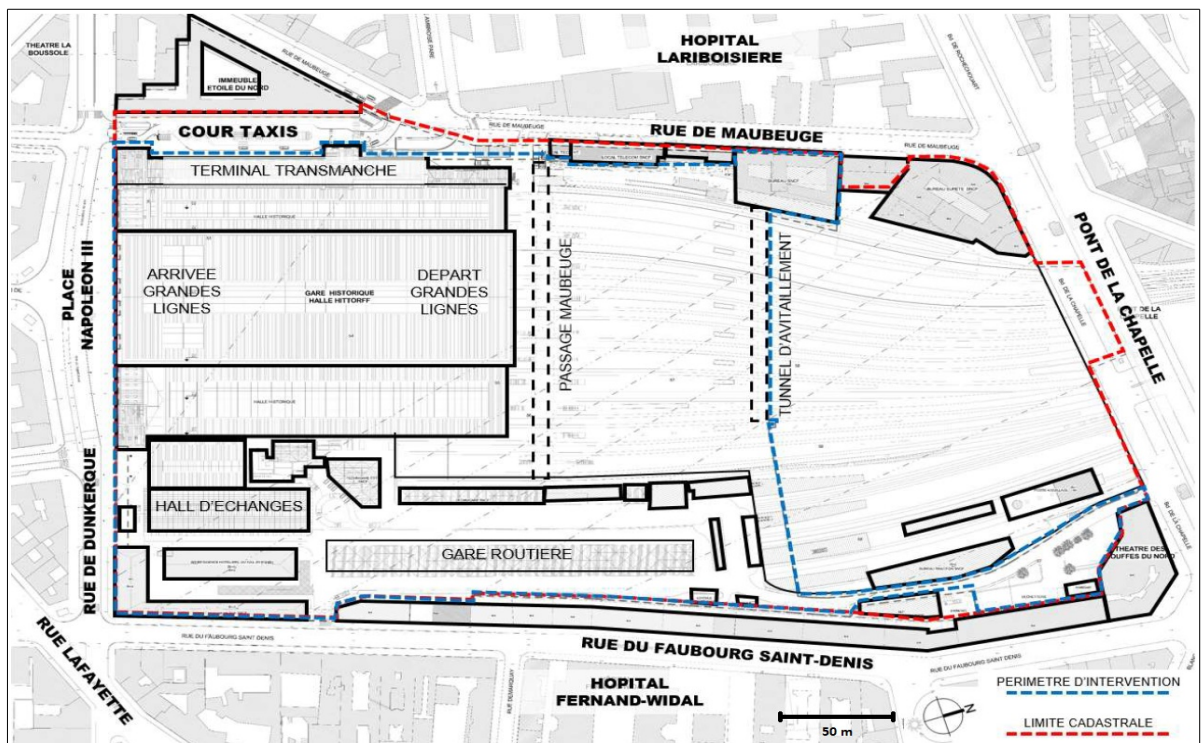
vue en plan du site d'implantation (source : étude d'impact, partie 2 p.26. Le nord se trouve sur la droite de la figure)
